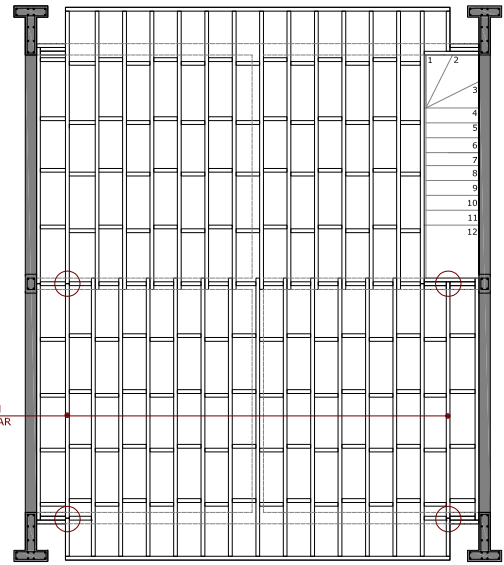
cambio orientación de la Vigas maestras del entramado de madera
